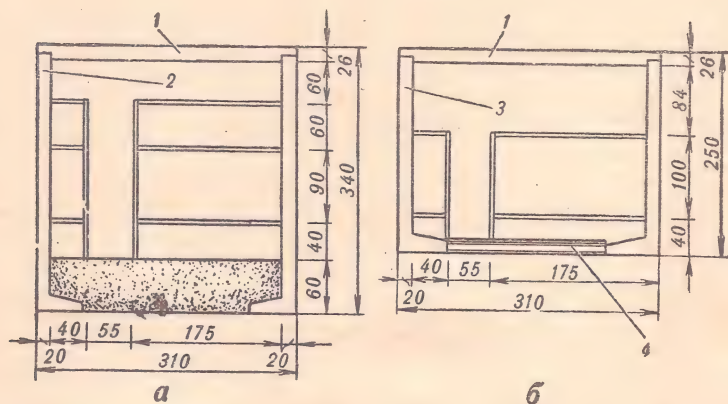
Наиболее целесообразное сочетание стеновых блоков (деталей) и плит перекрытия сухих коллекторов при строительстве быстровозводимых убежищ и укрытий:
